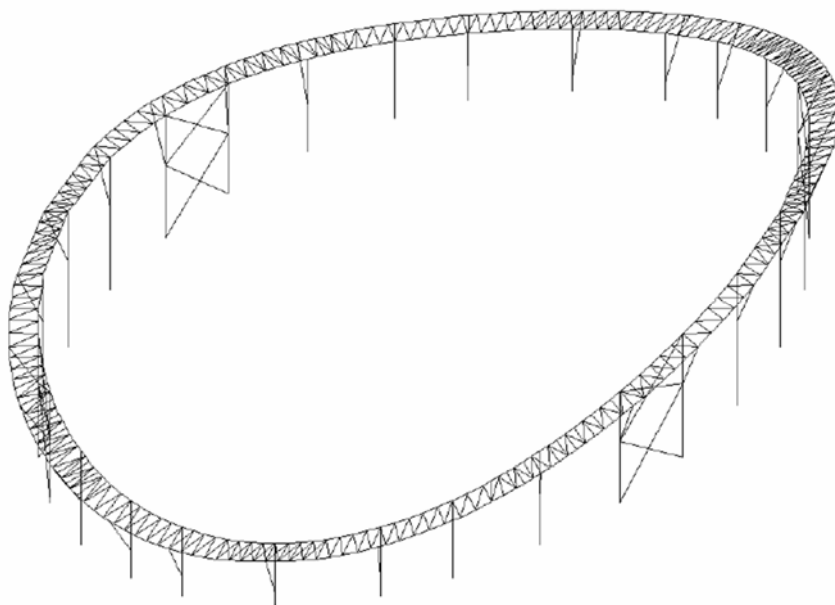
Загальний вигляд розрахункової схеми
